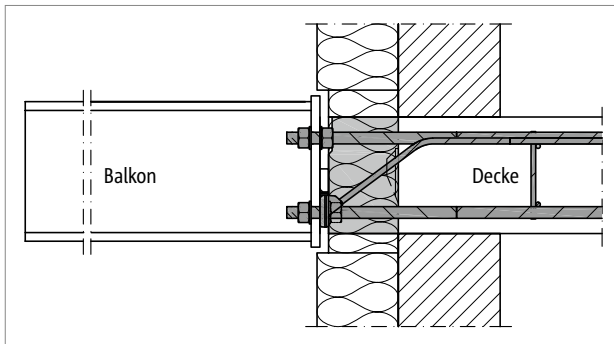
Schöck Isokorb® XT Typ SK: Anschluss an die Stahlbetondecke; Dämmkörper innerhalb der Außendämmung
